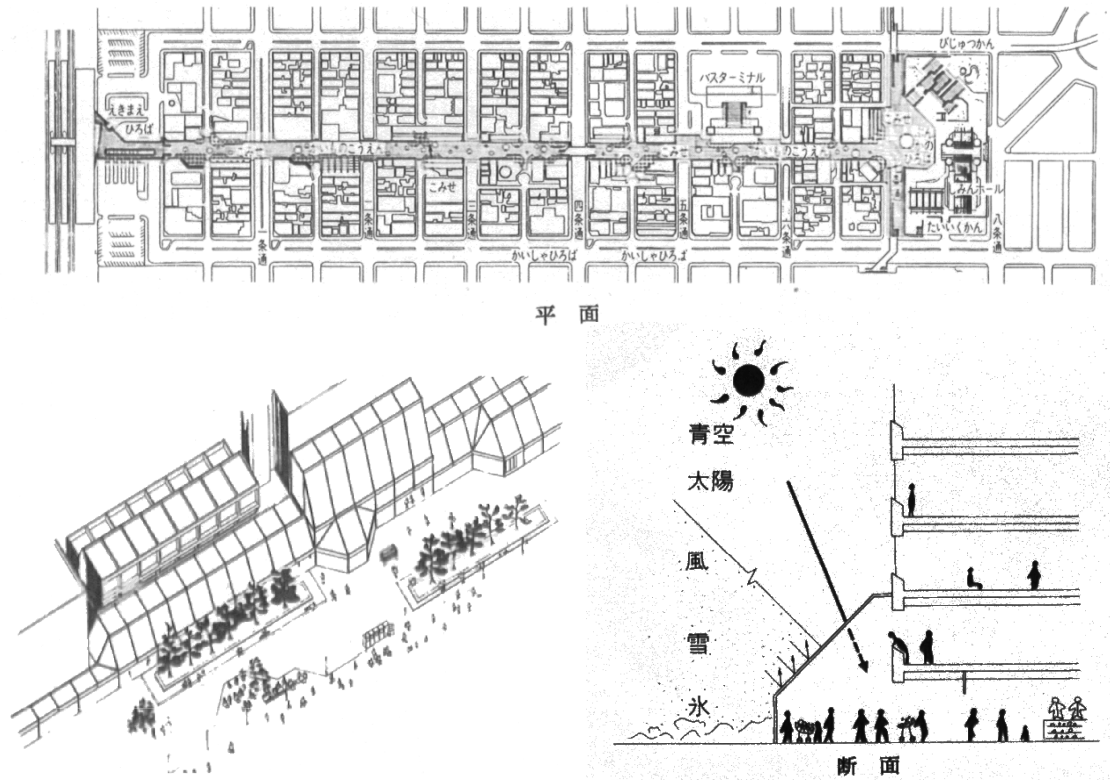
「こみせ」案の平面図・断面図・鳥瞰図（参考文献 17 より抜粋）
